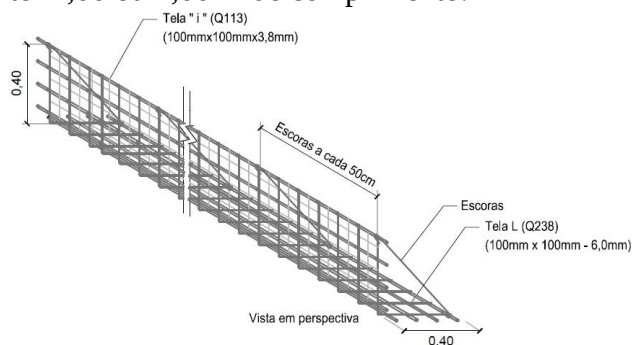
Vista geral do sistema *StrataSlope* utilizados para construção de face de aterro.
